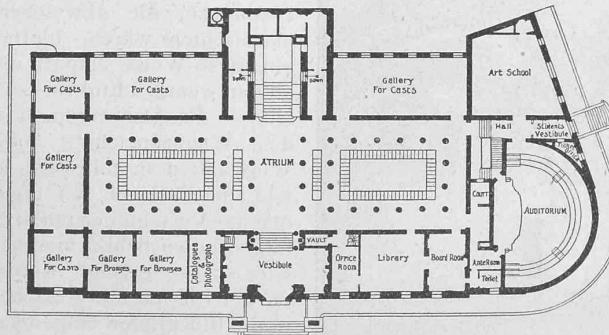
Washington. — Die Corcoran-Galerie. Grundriss 1:1000.
